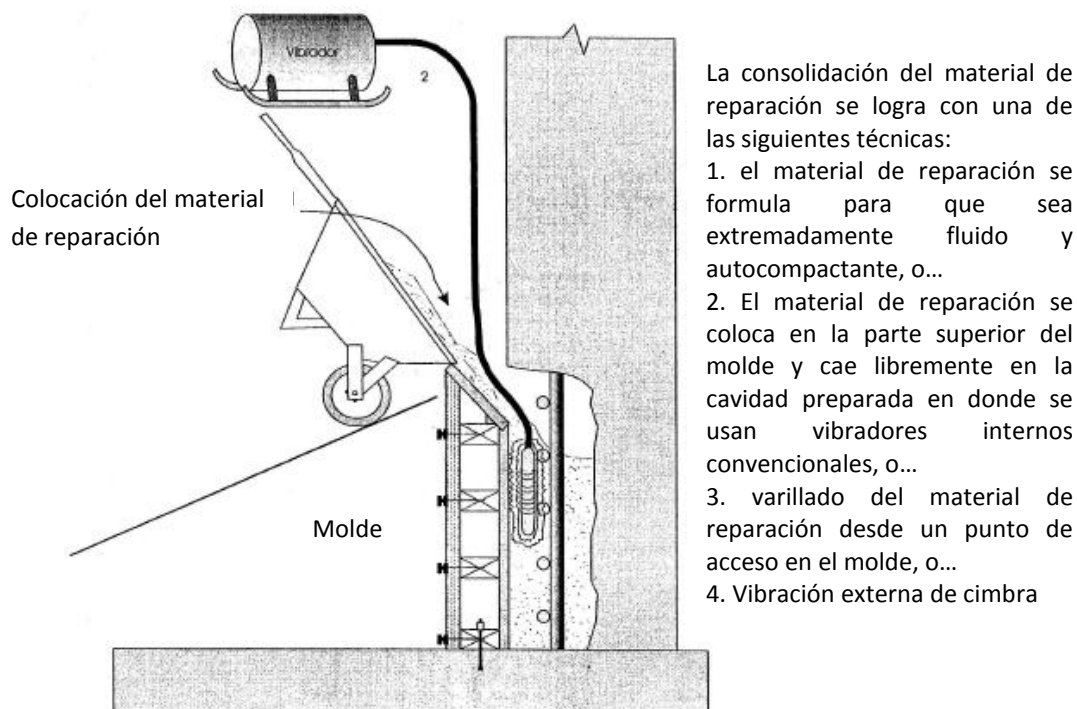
Estrategia de colocación “Cimbra y colado en obra”
